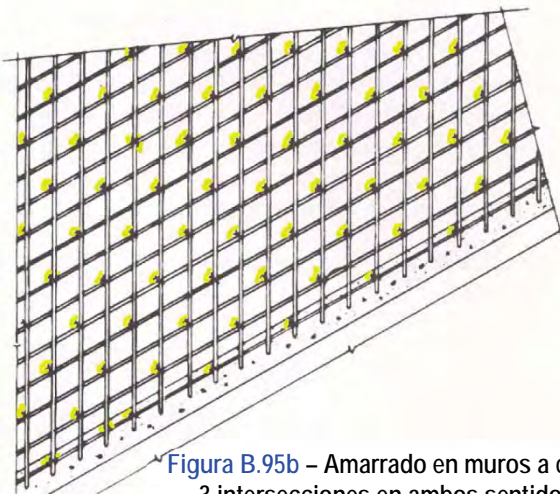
Amarrado en muros a cada 3 intersecciones en ambos sentidos
